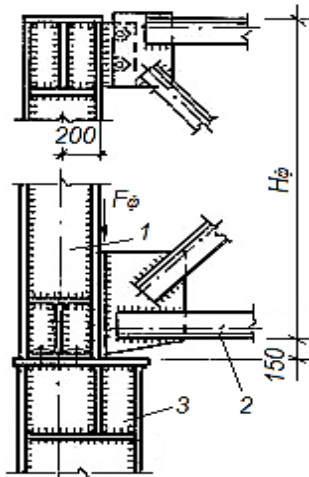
Шарнірне з'єднання колони з ригелем: 1 – надколонник; 2 – ферма; 3 – оголовок колони
